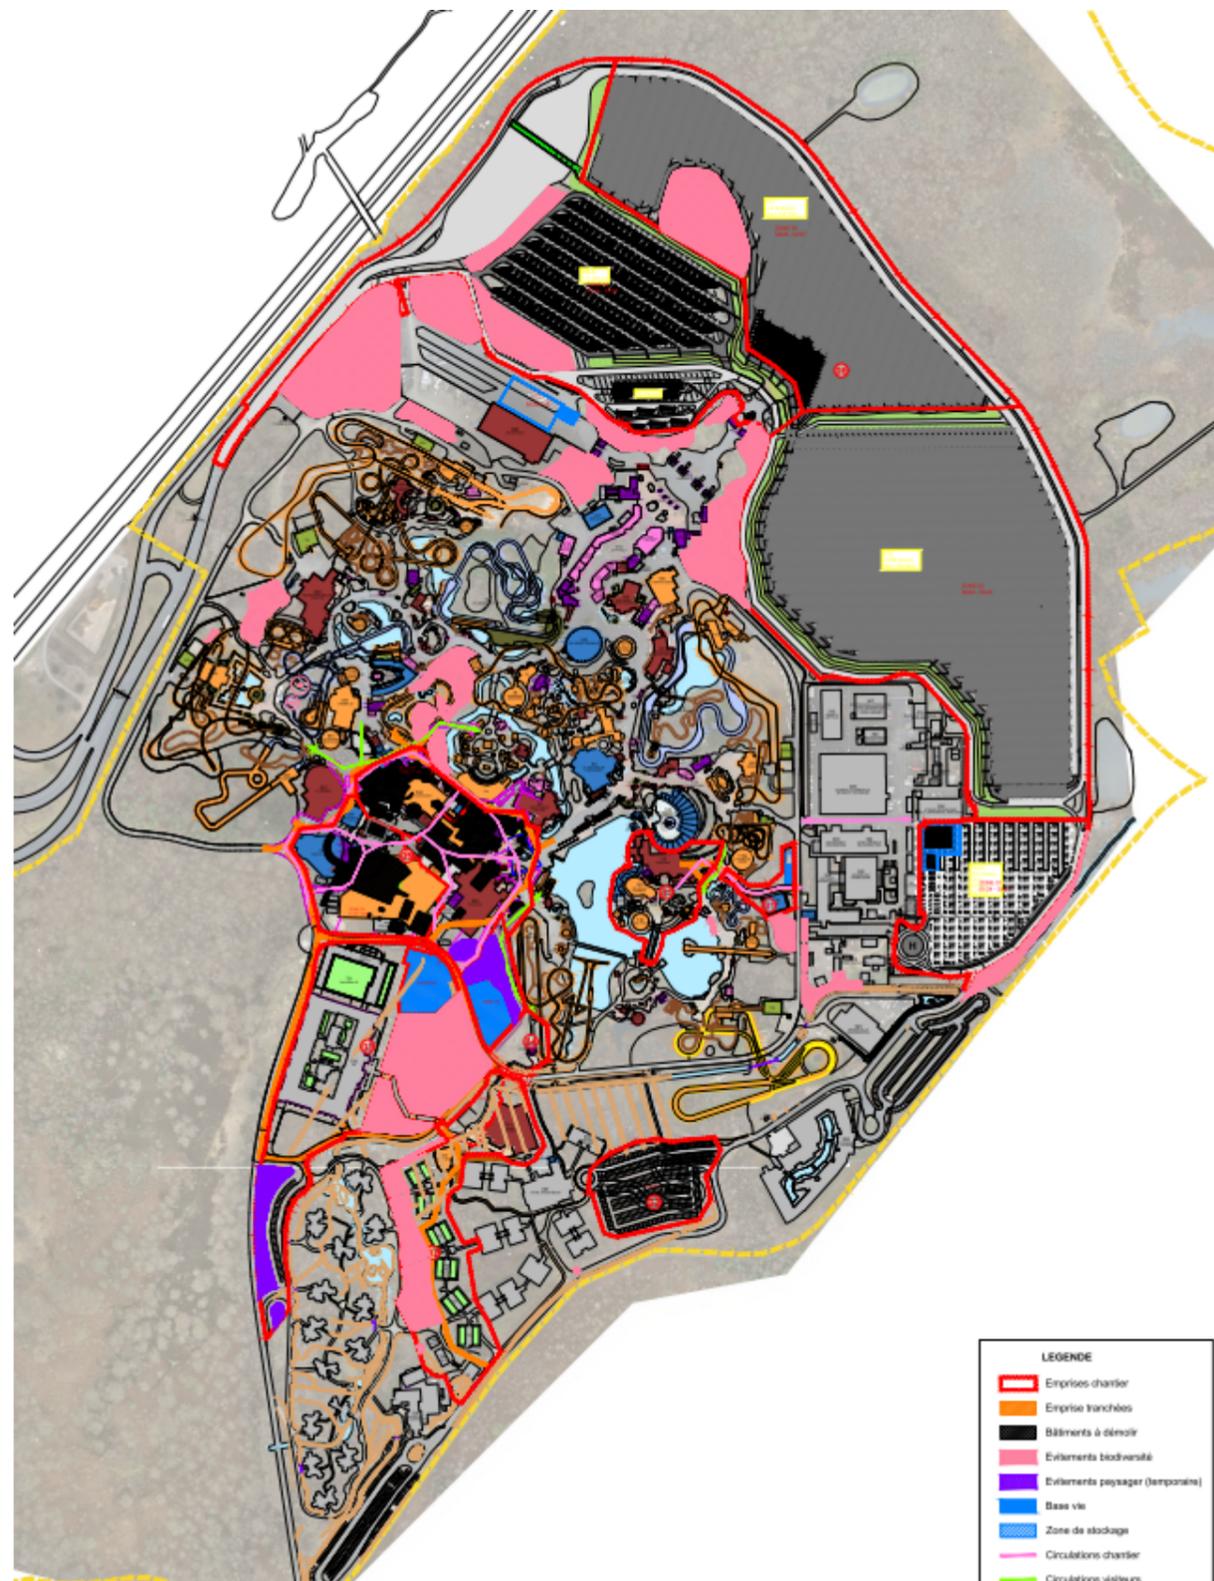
/ Plan général de chantier : emprises, démolitions, zones évitées
